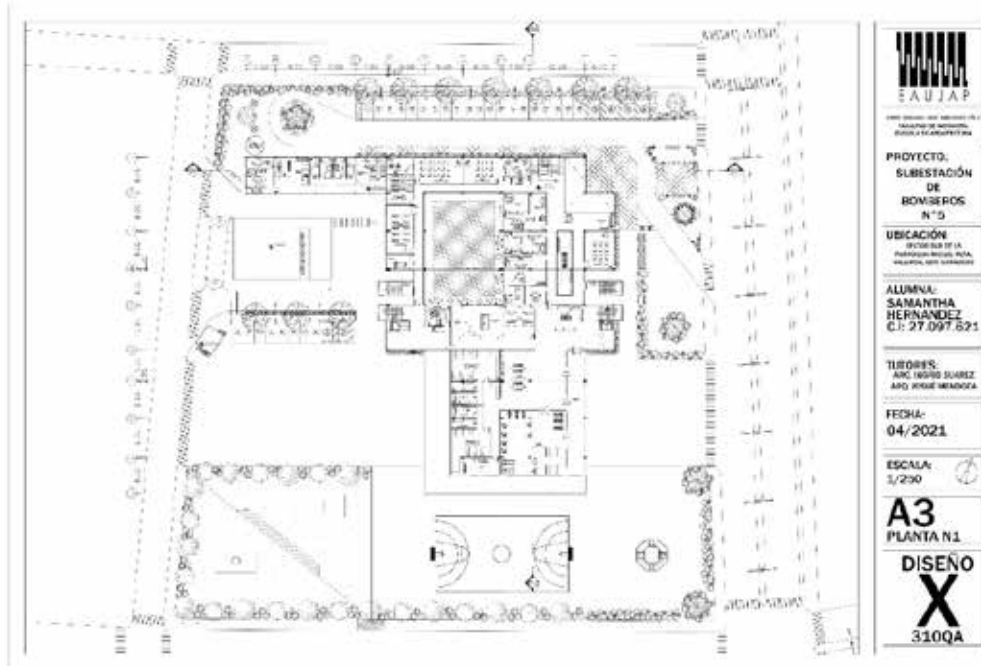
Planta Nivel 1 A3. Fuente: La Autora (2021)
